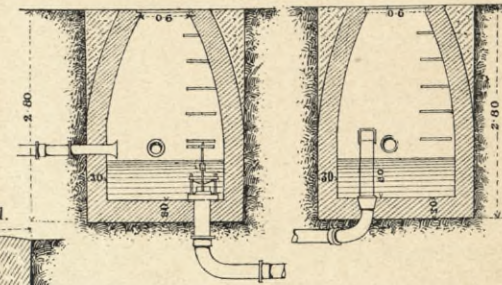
Quellsammelschacht. Fig. 9. Entlüftungsschacht.
